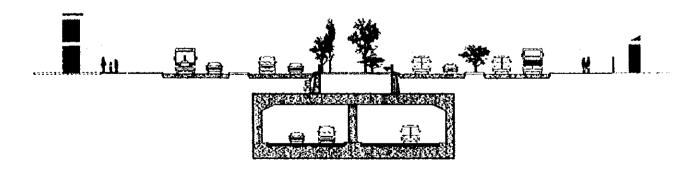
Sección típica del pase estructural por debajo el camino existente
